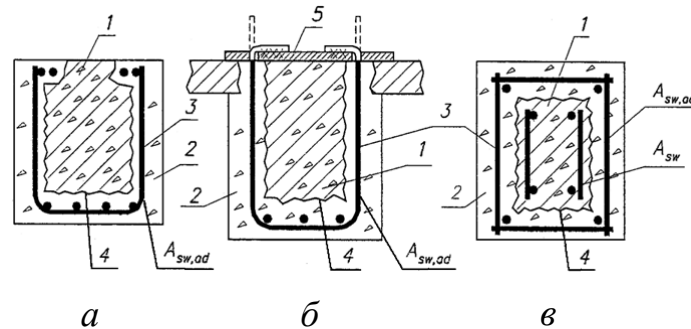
Підсилення зони зрізу конструкцій збільшенням поперечного перерізу залізобетонною сорочкою (див. зліва направо):
